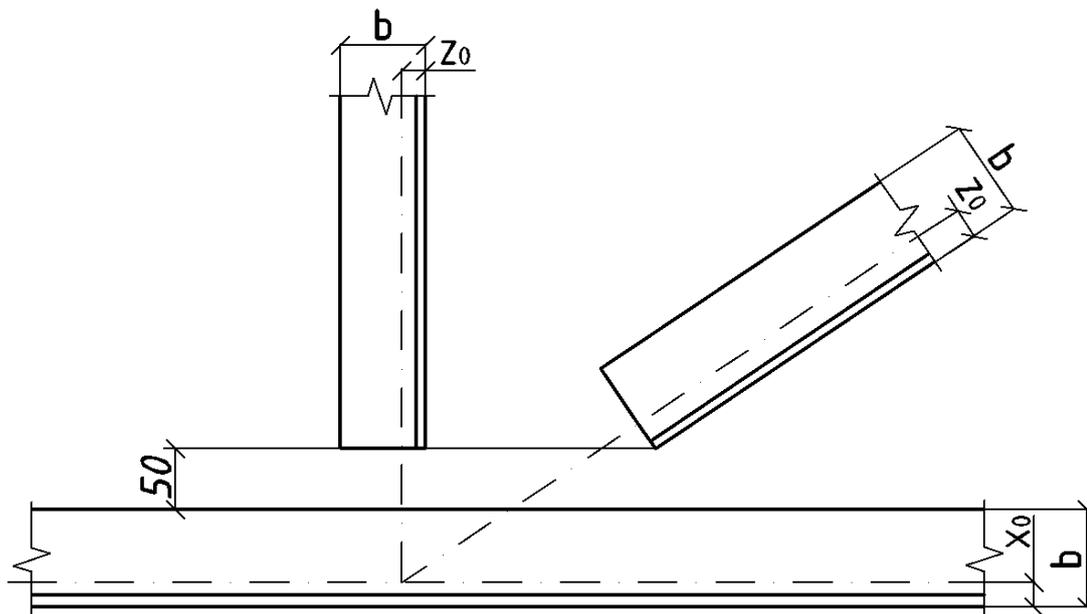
Второй этап выполнения главного вида узла нижнего пояса фермы
